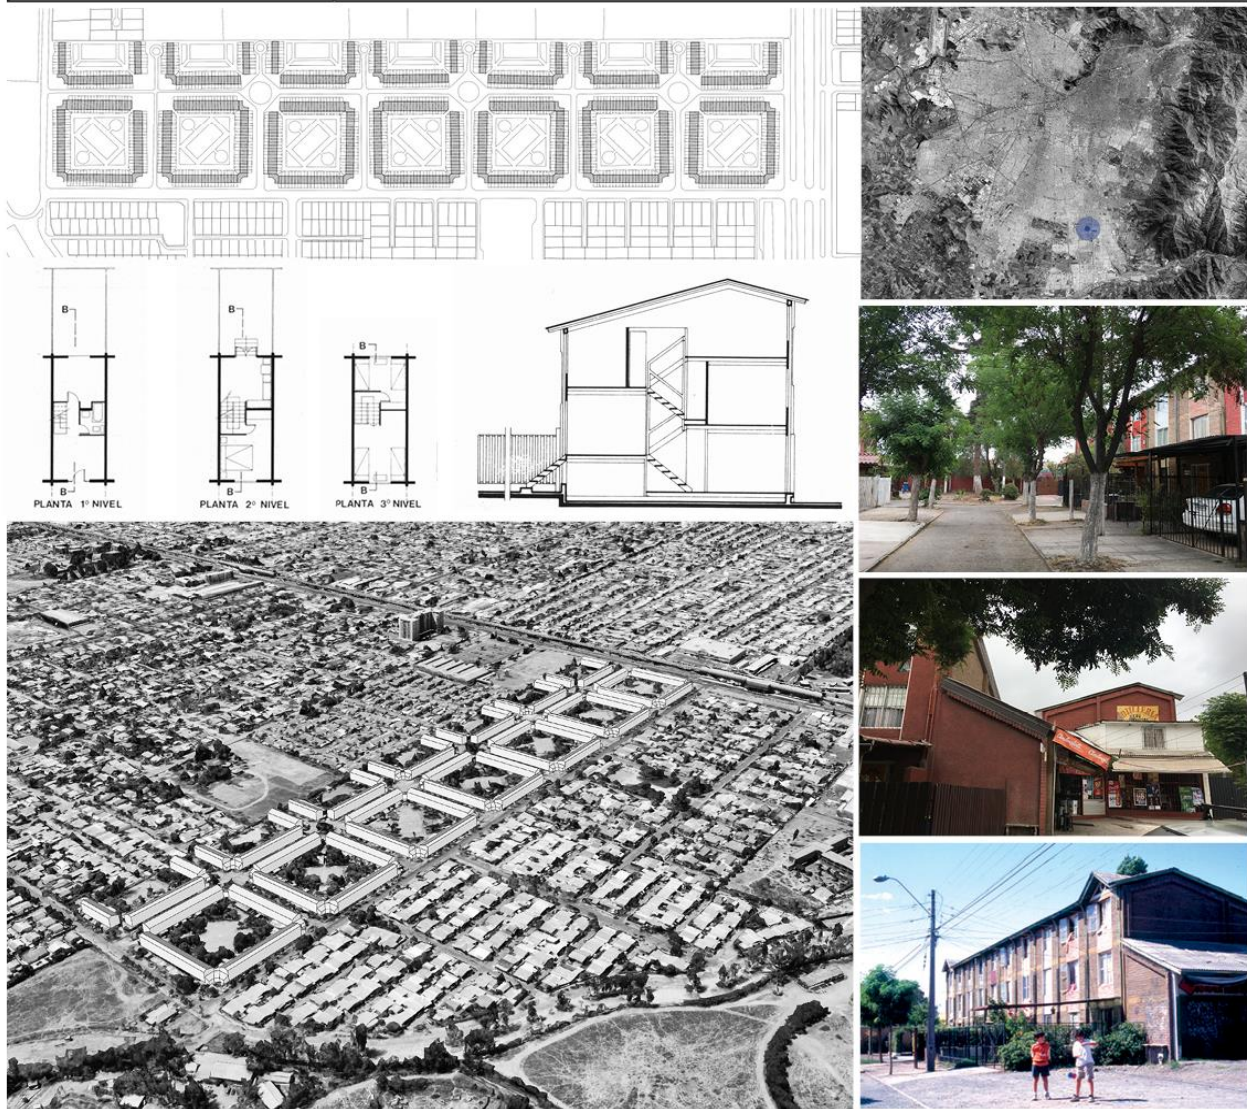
Ficha Los Sauces. / Planta conjunto, plano ubicación y vista aérea: elaboración propia. / Imágenes 1y 2: archivo de la autora (2019) / Planimetría vivienda e imagen 3: gentileza arquitecto Francisco Vergara D.
